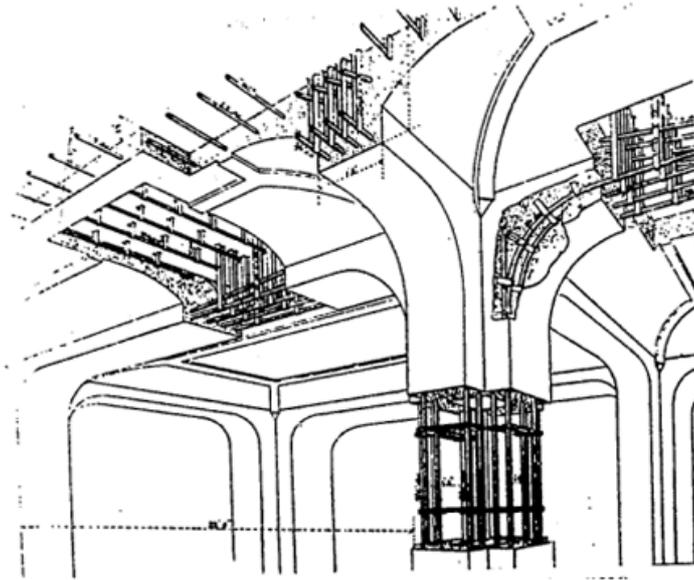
Detalle constructivo de hormigón armado de Hennebique; Fuente: De la construcción a los proyectos (James Strike)
